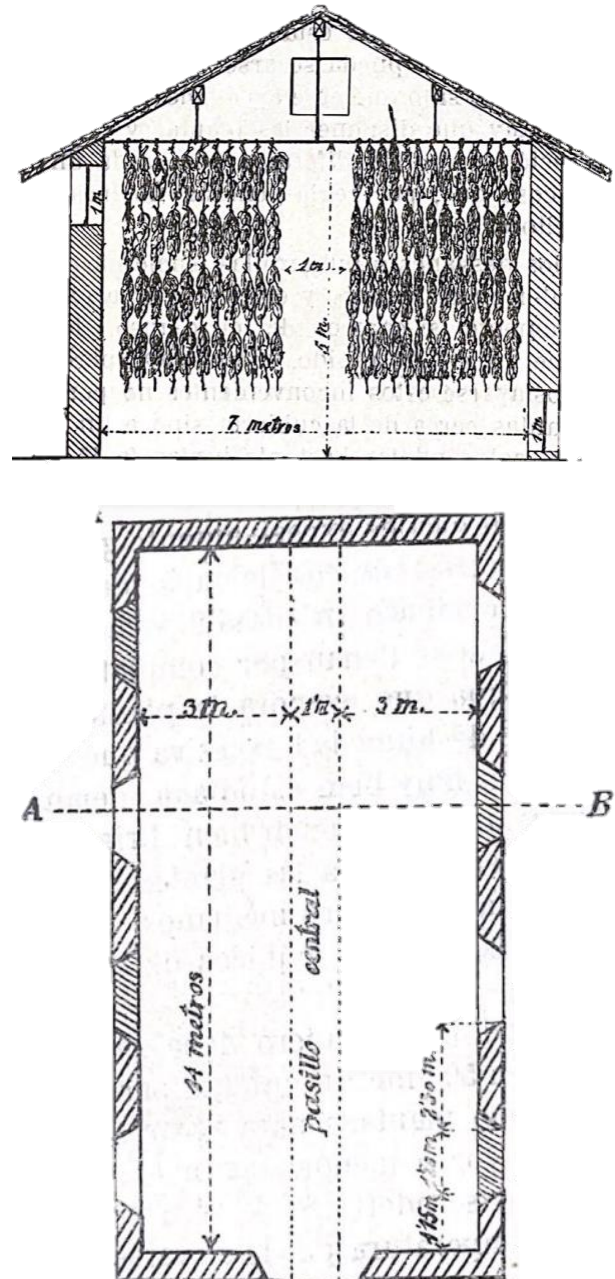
Sección y planta de un secadero modelo para una hectárea de terreno – Secado al aire (Carrión, 1927).
